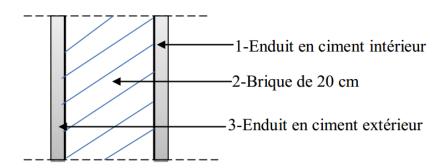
Coupe transversale des murs intérieurs (type 2).
